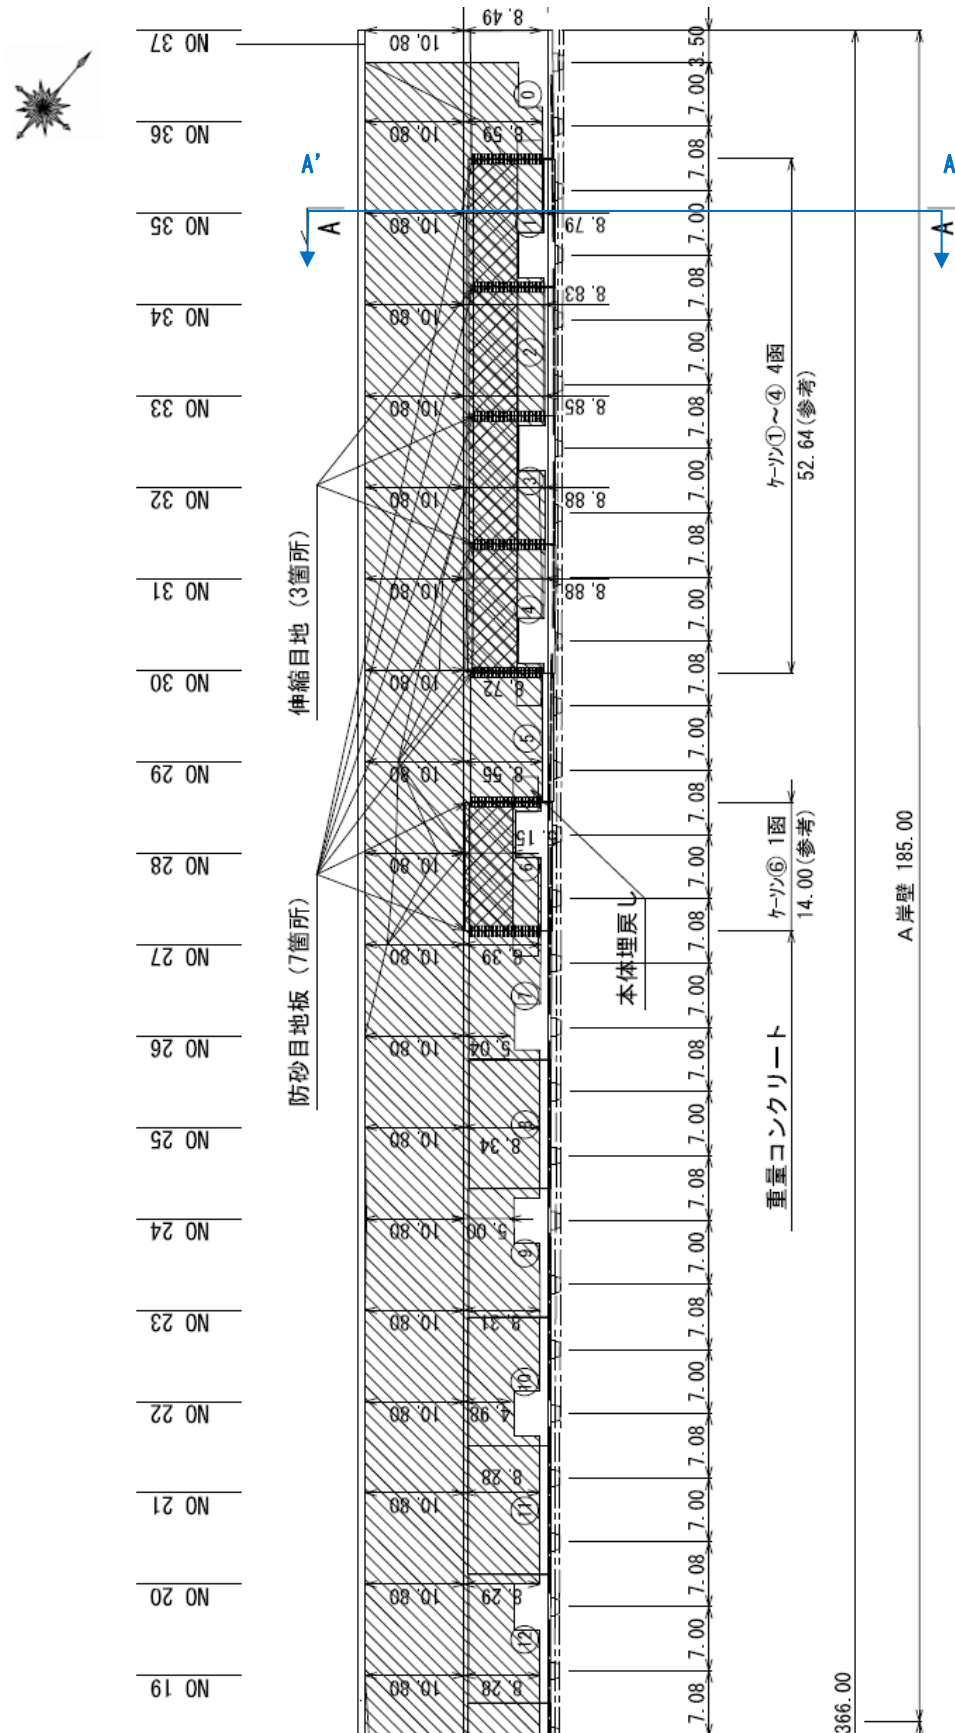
No.5 南公共ふ頭 A 岸壁(-10m)平面図 (復旧後)
